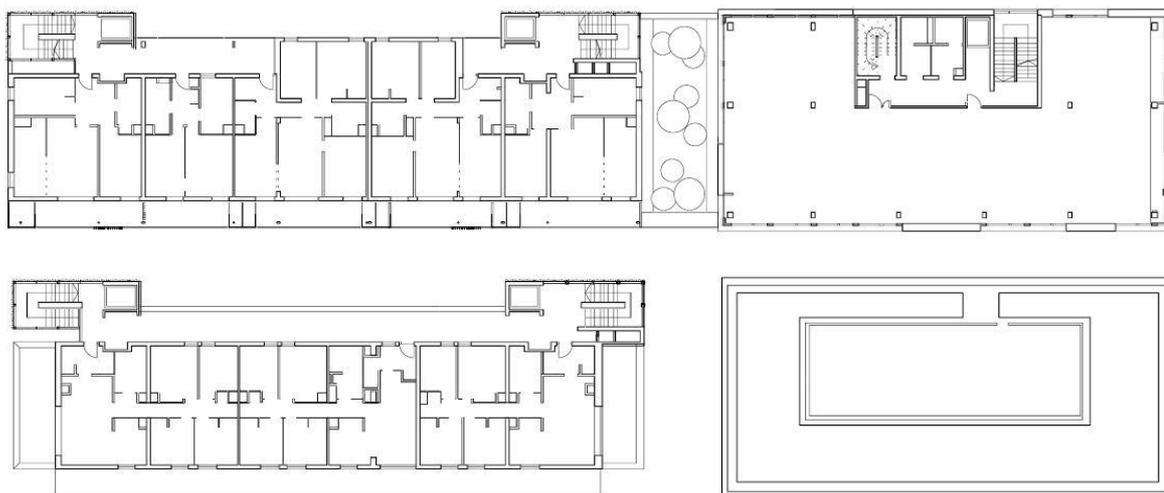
Planta do pavimento tipo e cobertura do Bloco 32
